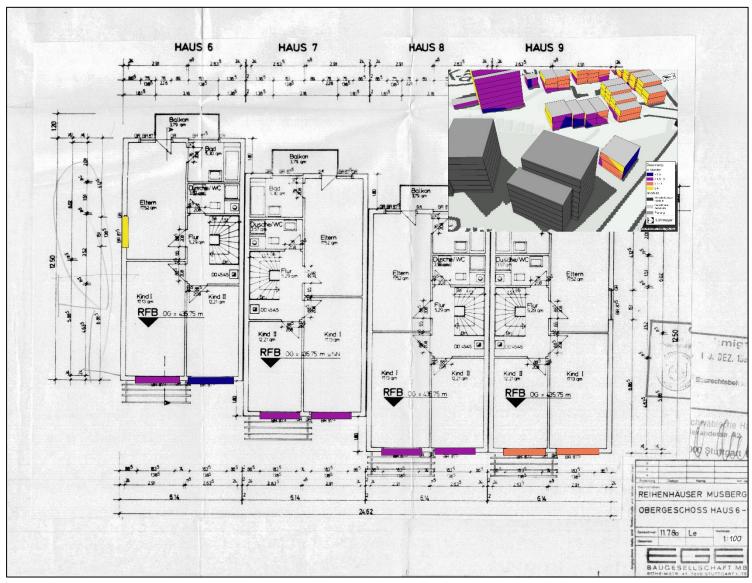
Grundrisse der Kapfstraße 42 bis 48 im 1. Obergeschoss und direkte Besonnungsdauer an den zur Planung zugewandten Fenstern
